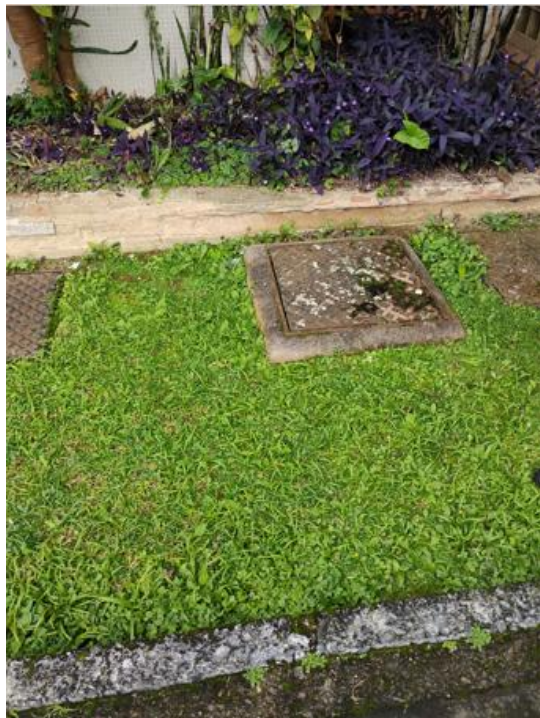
Caixa 3 (fechada): Passagem subterrânea do cabeamento, próximo à fachada do prédio do LNCC.
